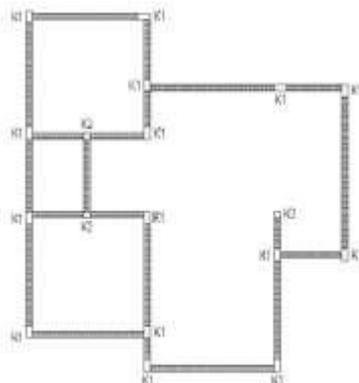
Denah lantai 1 dan lantai 2 (unit satuan cm)
